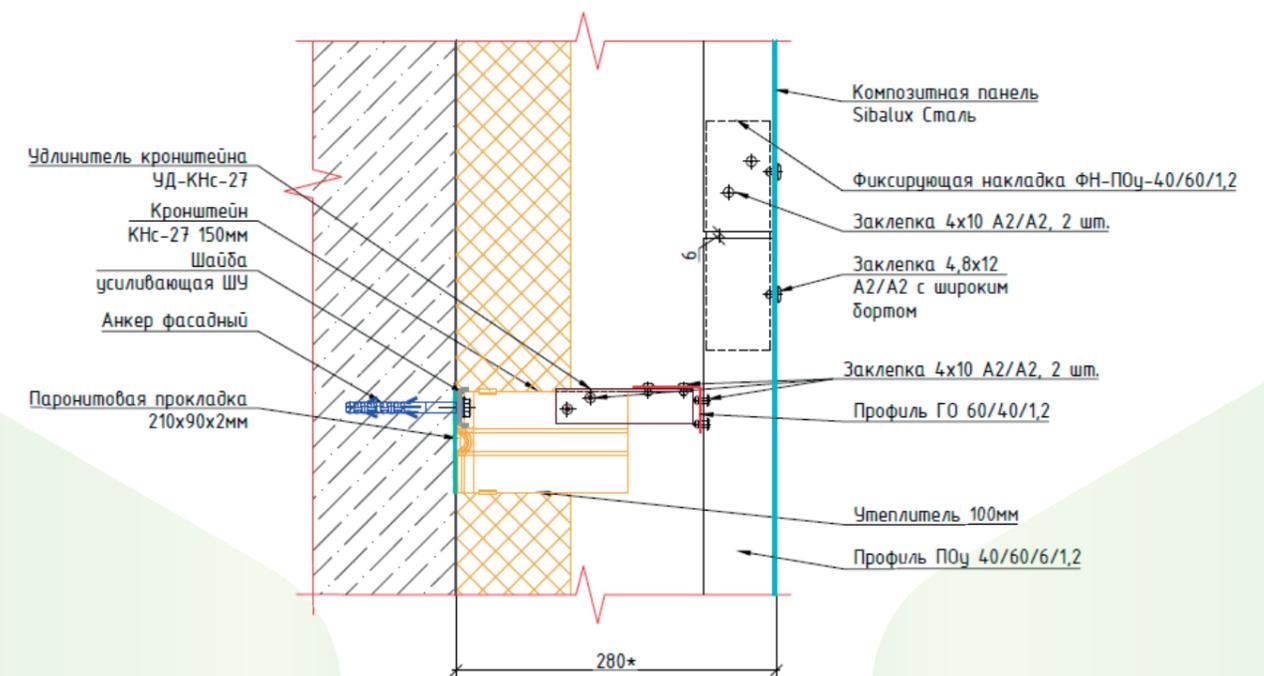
Вертикальный разрез навесной фасадной системы (на примере Альт-Фасад-06) для п. 6
